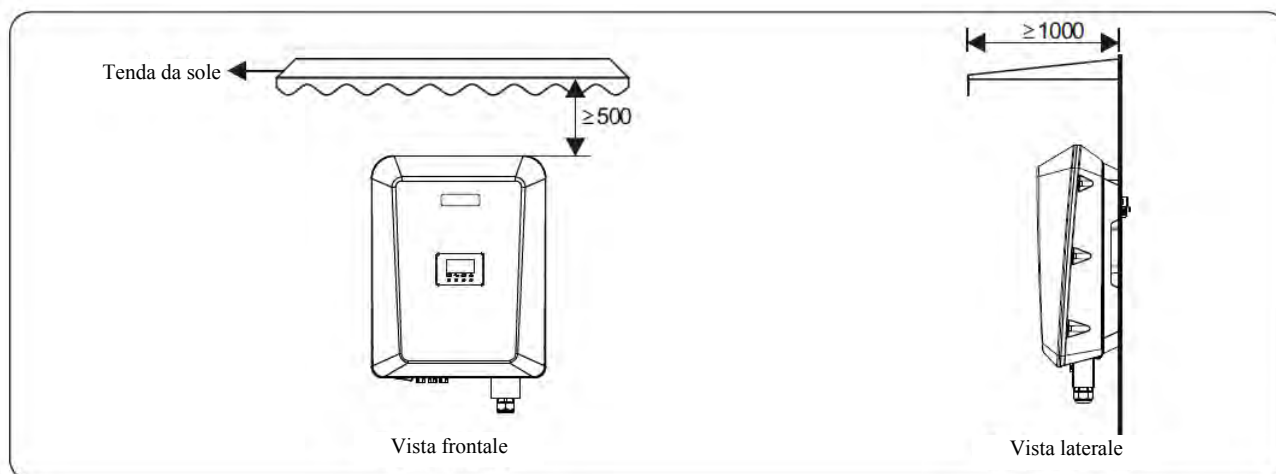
Ambiente di installazione con tenda (unità: mm)
